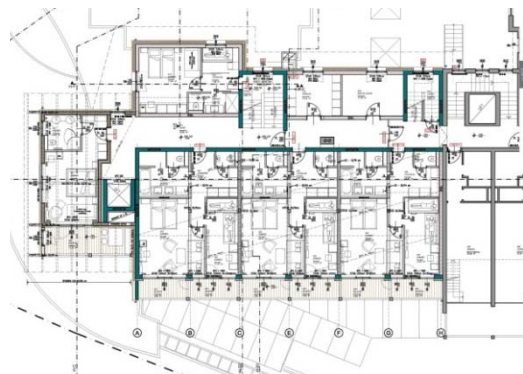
Grundriss Hotel Brennseehof
